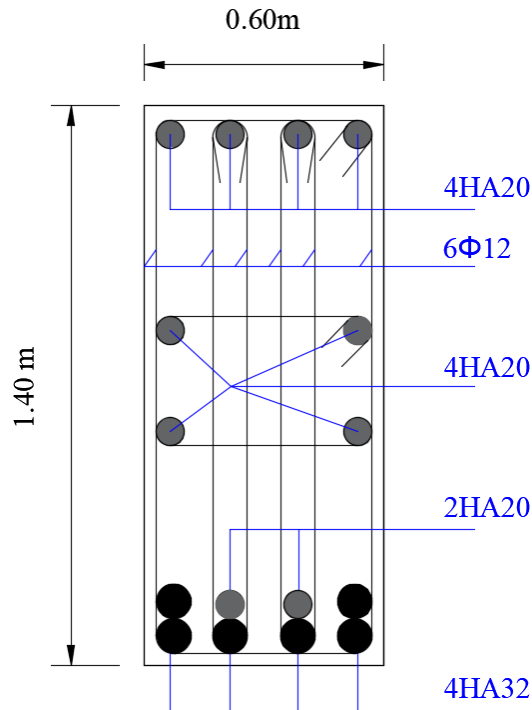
ferrailage de la poutre principale (60×140) sur appui
